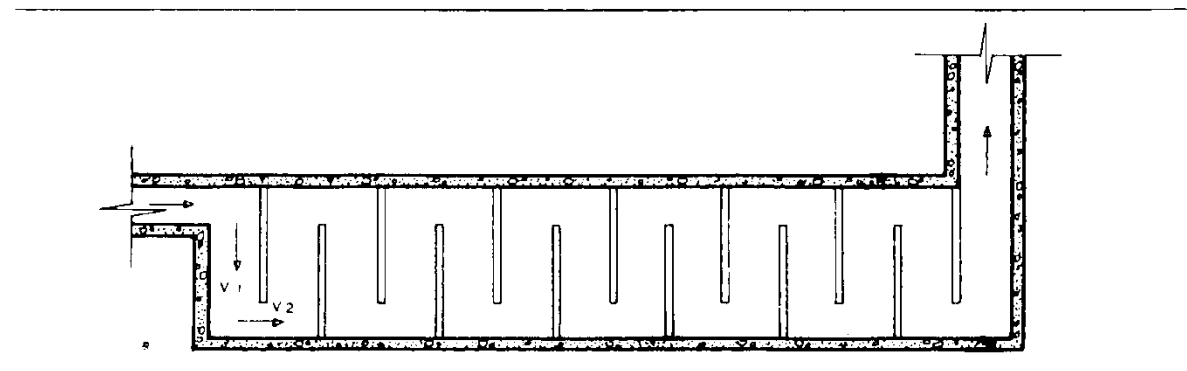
Câmara com chicanas de fluxo horizontal – planta.
